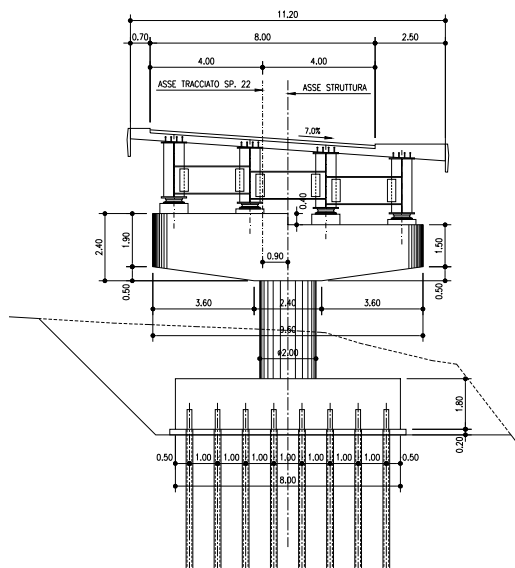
Pila 1 e 2 – Pianta Fondazioni
